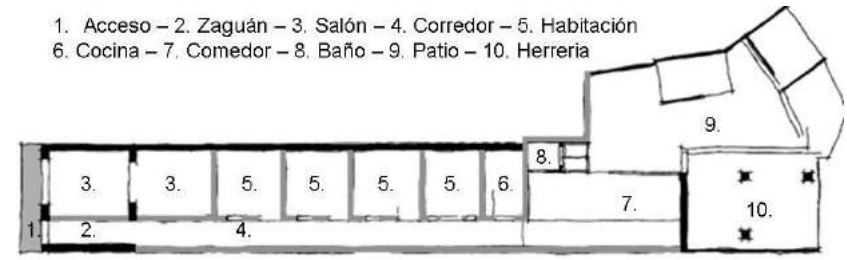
Planta de la edificación donde se desarrollaba el oficio de Alpargates para Ganado.
